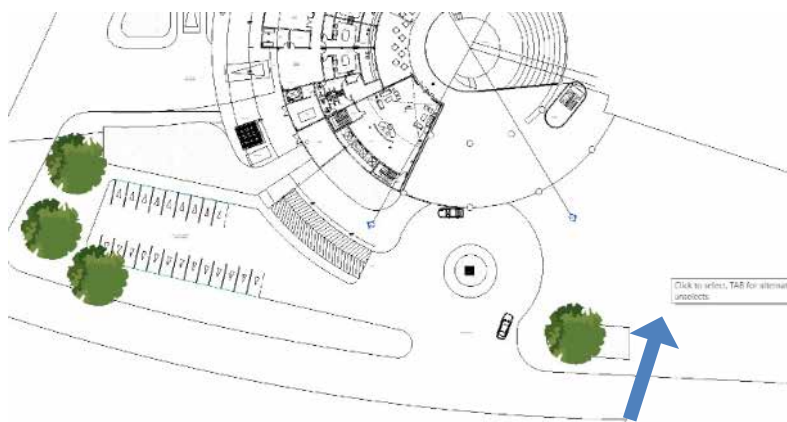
Plano de señalización de acceso vehicular. Fuente: Plano Planta Baja (2019)
